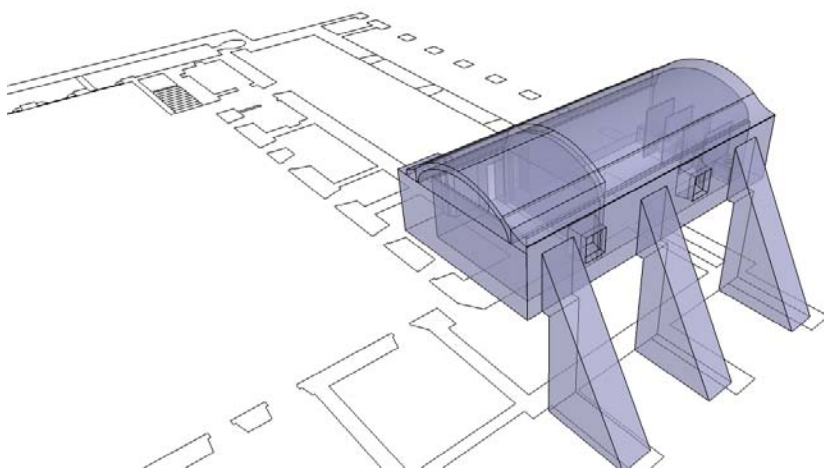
Reconstrucción Virtual Sector 4 b: Ala Este Planta Alta.
